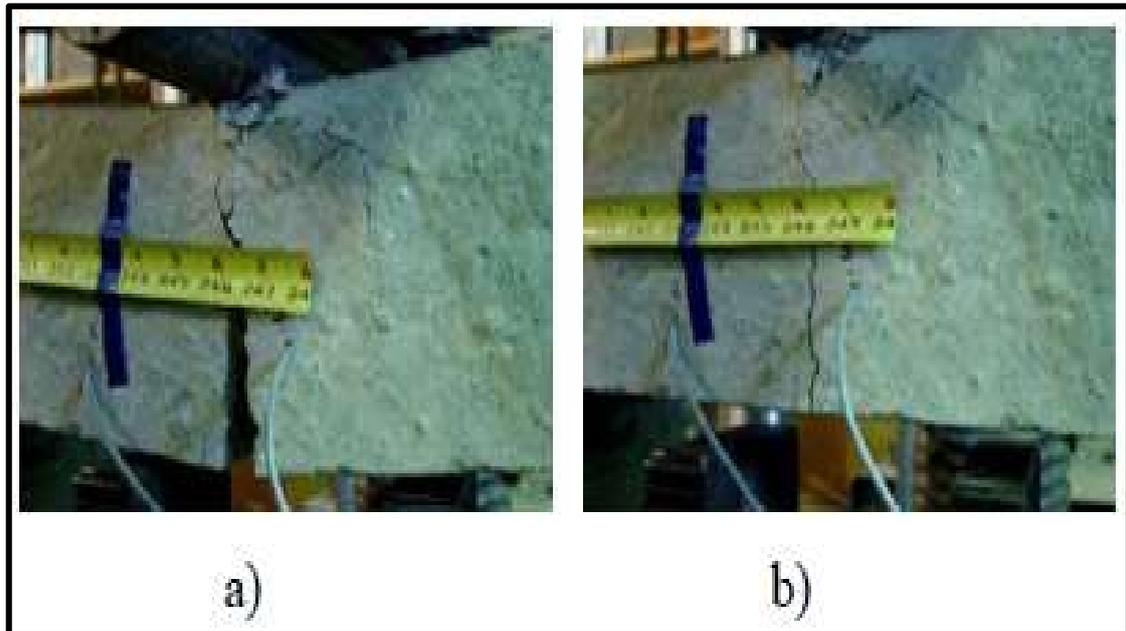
Poutre contenant des fils en AMF. a) ouverture de fissures provoquée par chargement mécanique, b) fermeture de fissures grâce à auto-restauration.
